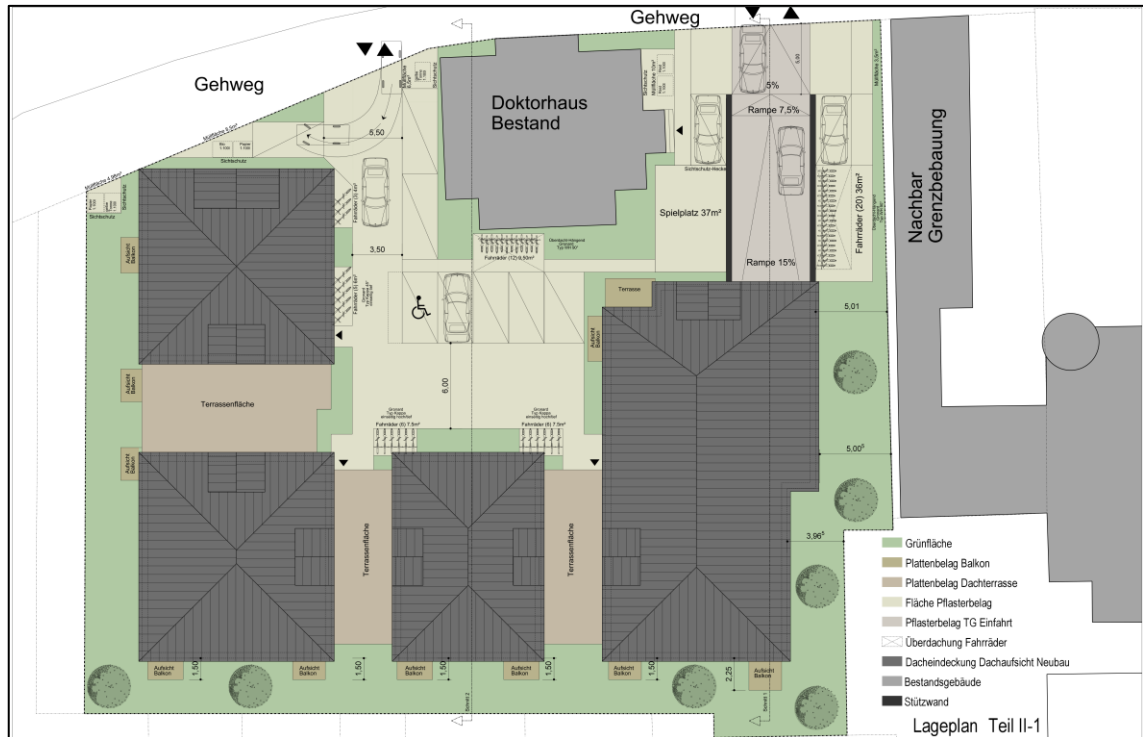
Lageplan (Quelle: M&P Architekten)
